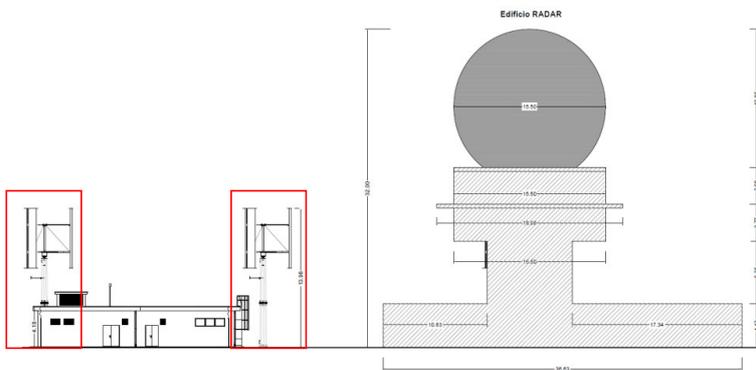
Sezione di progetto con individuazione delle pale mini-eoliche(in rosso)
